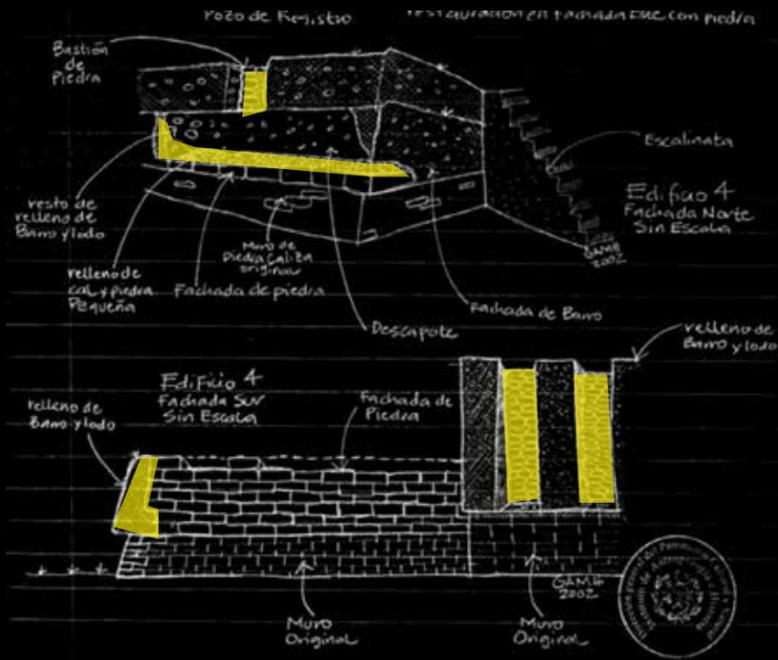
Dibujo Edificio 4 Fachada norte, esquina noroeste, primer y segundo cuerpo. Reintegración del núcleo de argamasa y cal y fachada de piedra, Descapote de relleno de lodo reciclado. Dibujo: GAMH 2002
